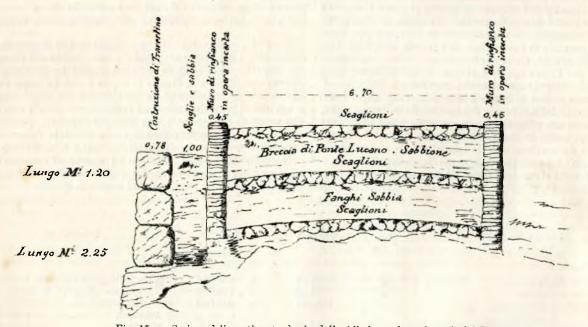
Sezione della antica strada che dalle Albule conduce al casale del Barco.
